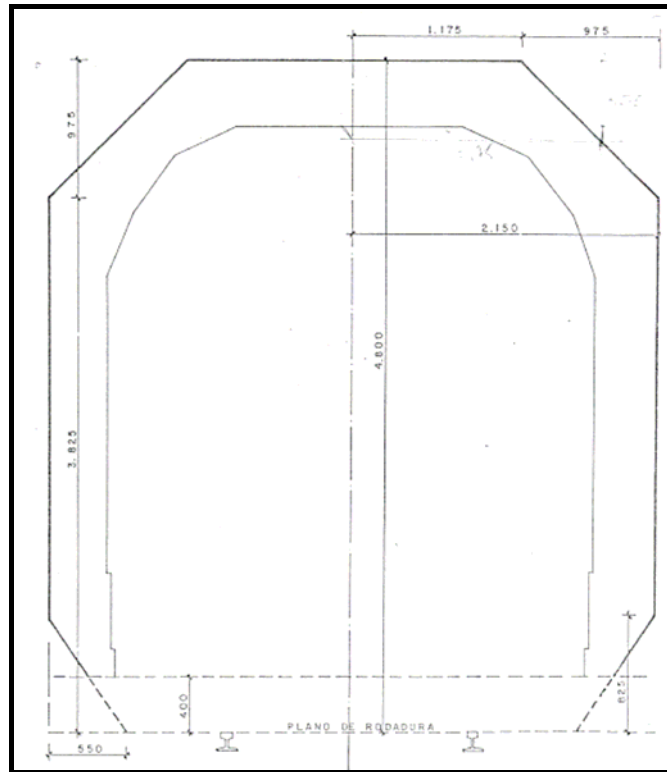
Gálibo de implantación de obstáculos, en vía recta.
